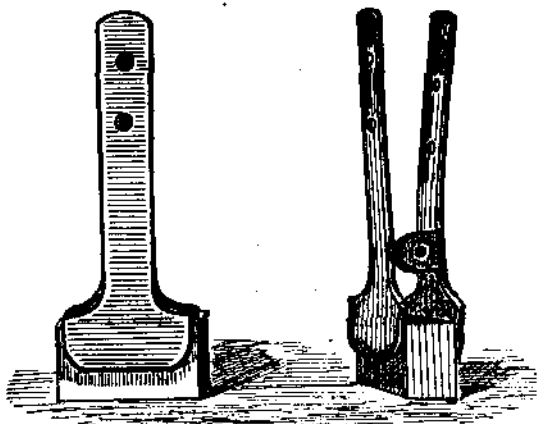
Передвижной держатель для соединения стоек и перекладин для внутренних лесов.
